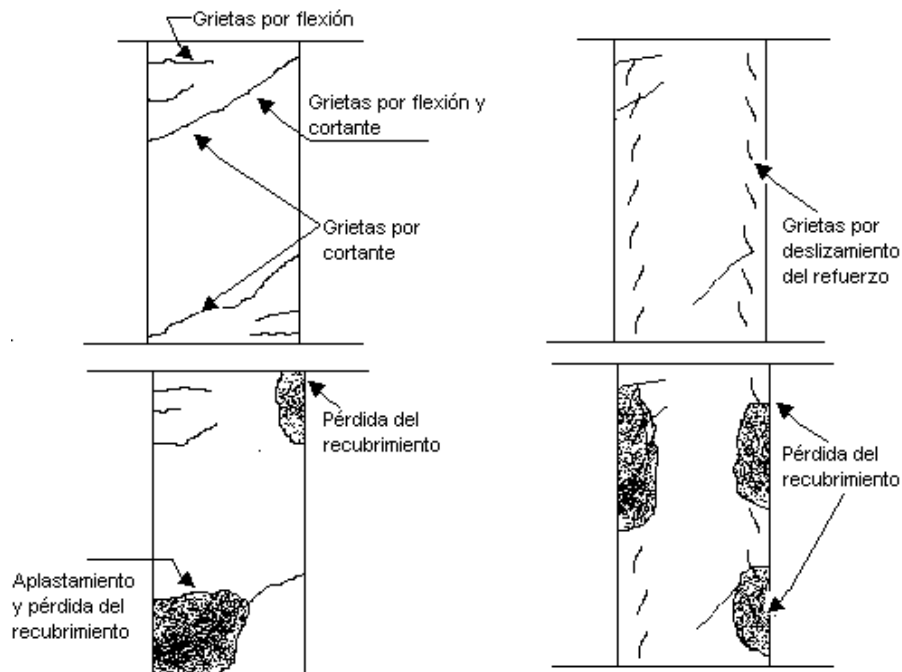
Agrietamiento típico en columnas de concreto
